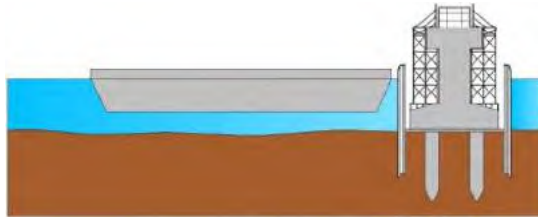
Pemasangan bekisting dan pembedian pier head
